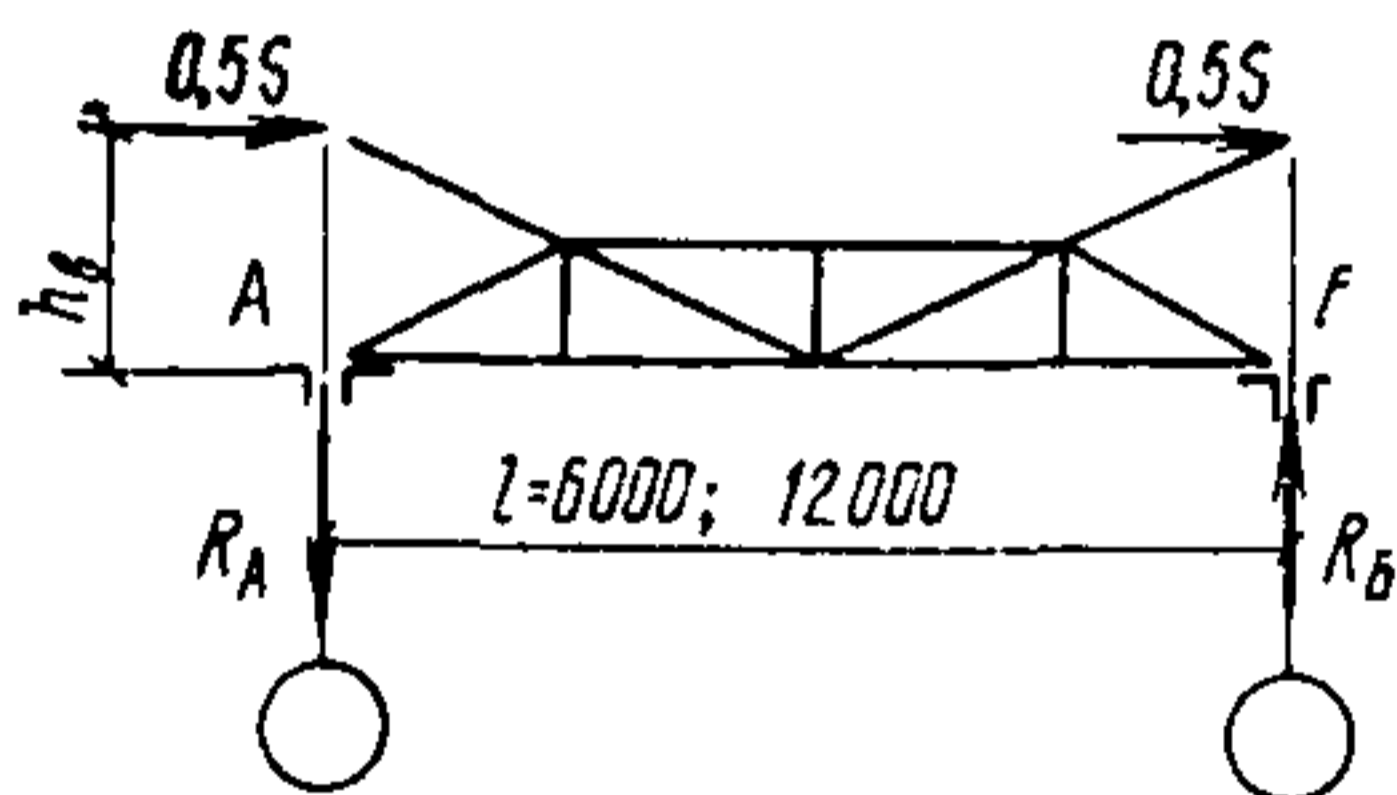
Расчетная схема вертикальной связи между фонарными фермами
